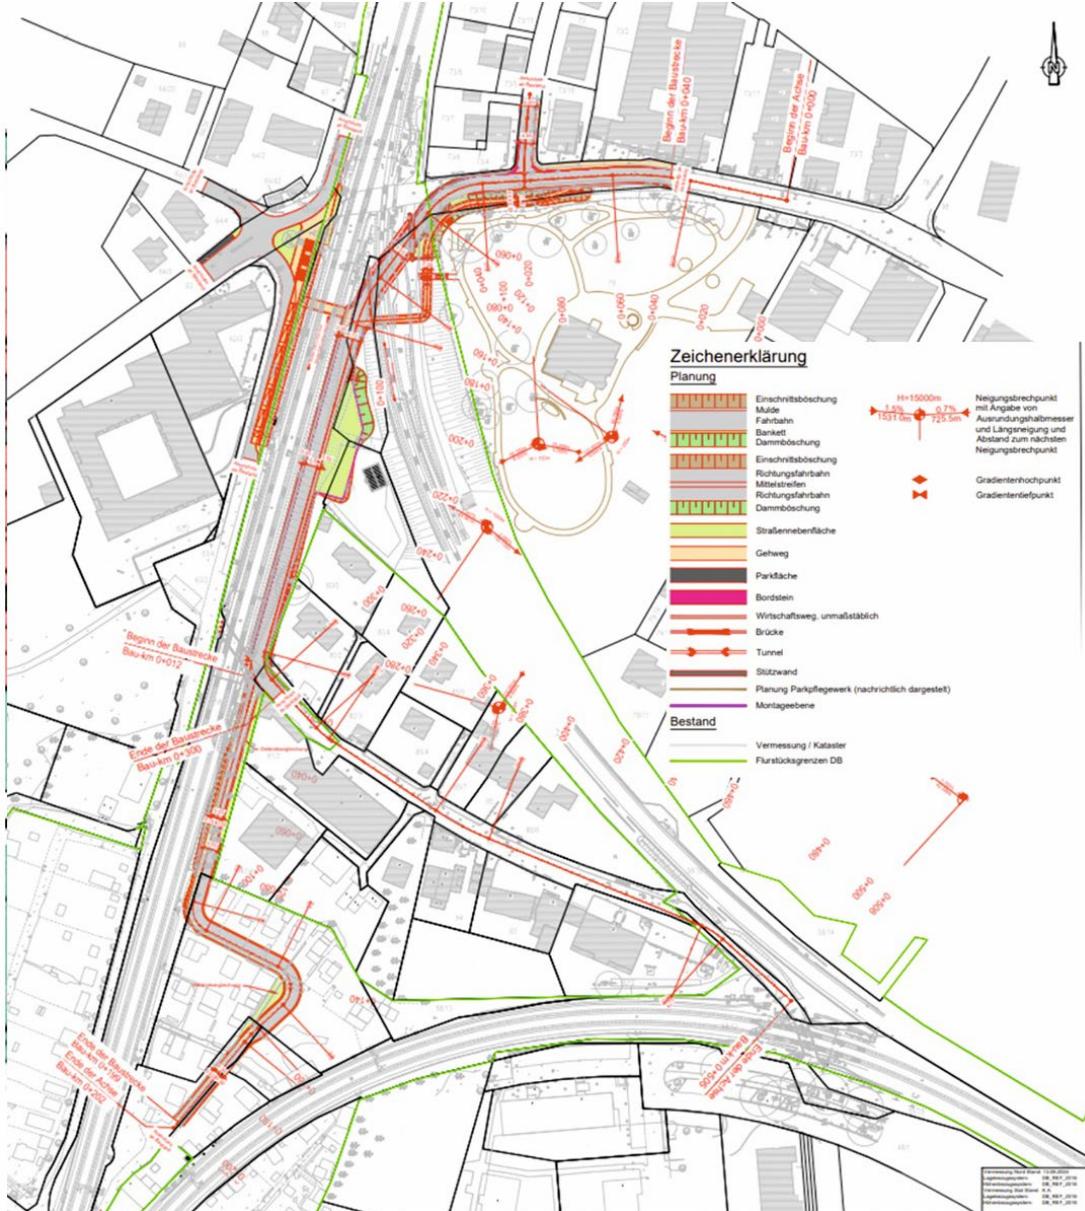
Übersichtslageplan der Variante 3.3 (Konstruktionsgruppe Bauen AG, 2024), verändert durch Planstatt Senner GmbH (2024), ohne Maßstab
